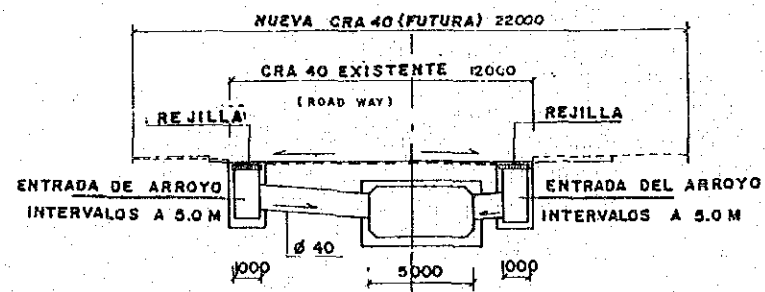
DRENAJE PRINCIPAL NO. 2
